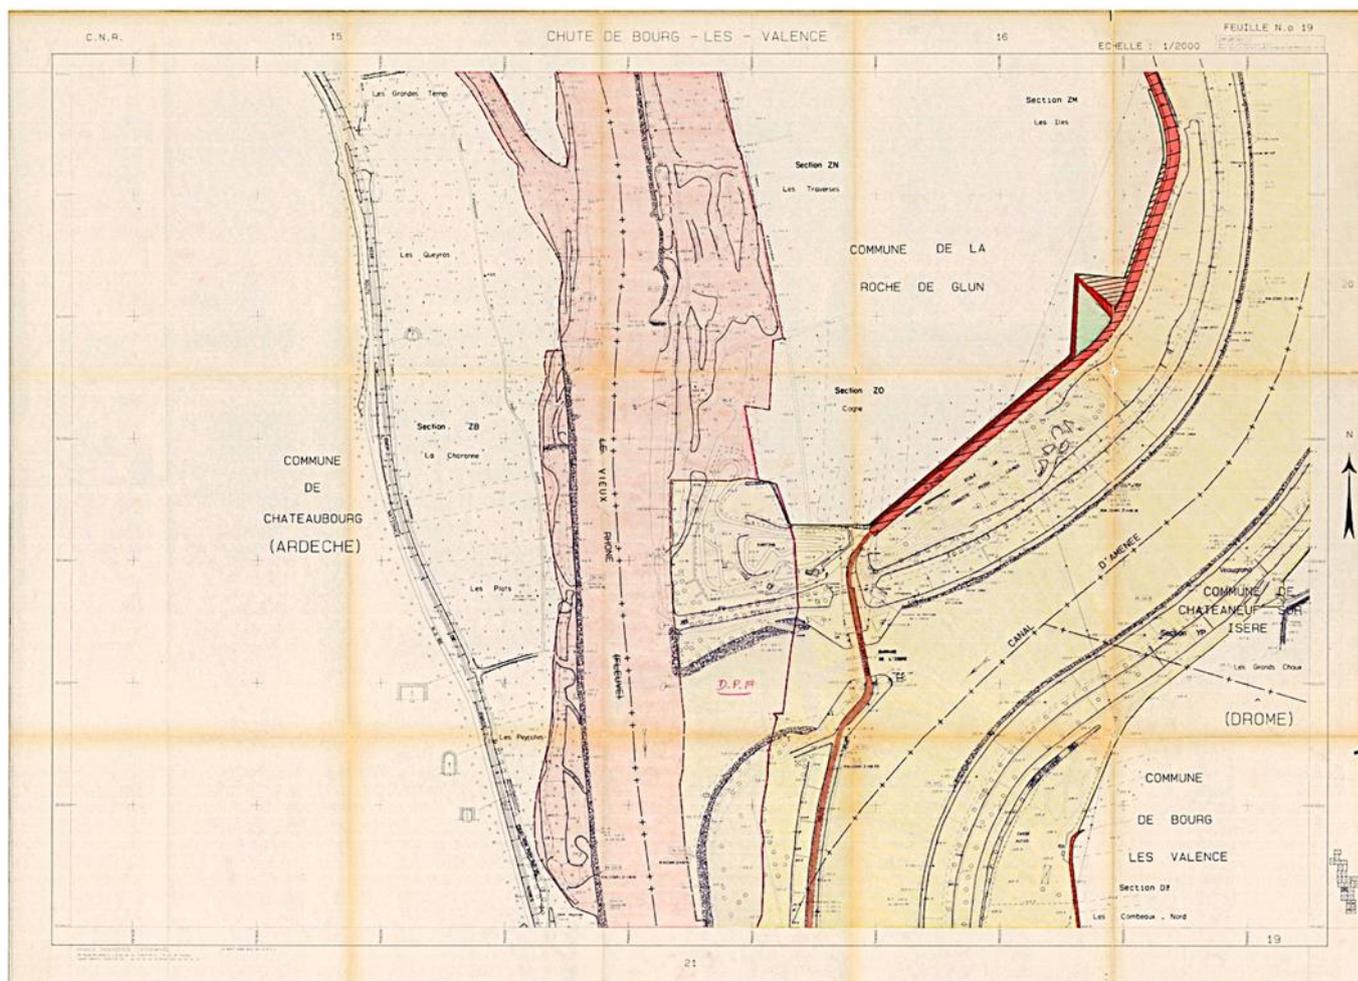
Planche après travaux, 1989 – secteur Isère - CNR
